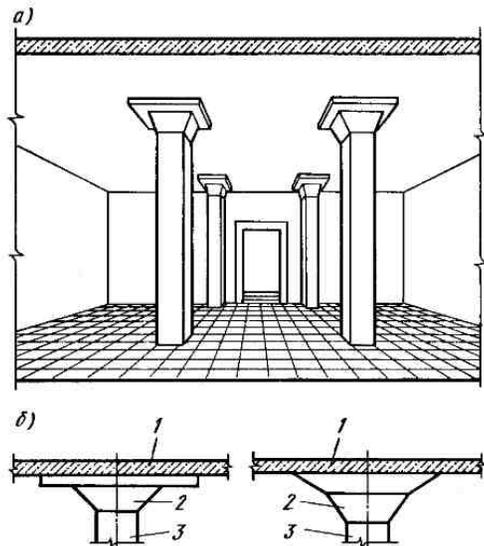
Железобетонное монолитное безбалочное перекрытие:
